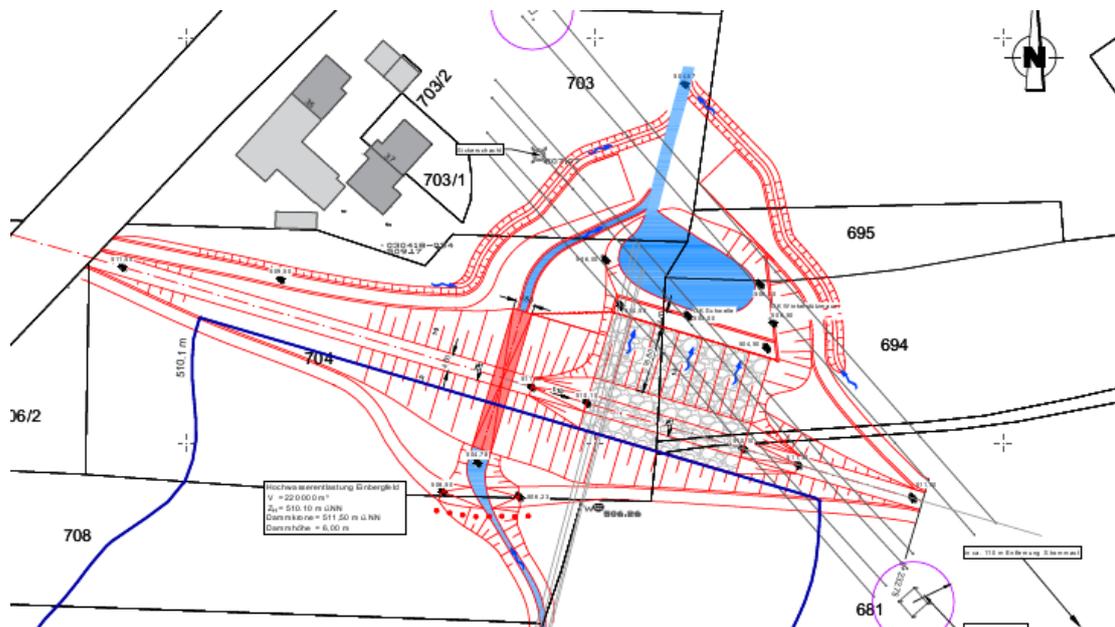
Lageplanausschnitt (Dammbauwerk)
